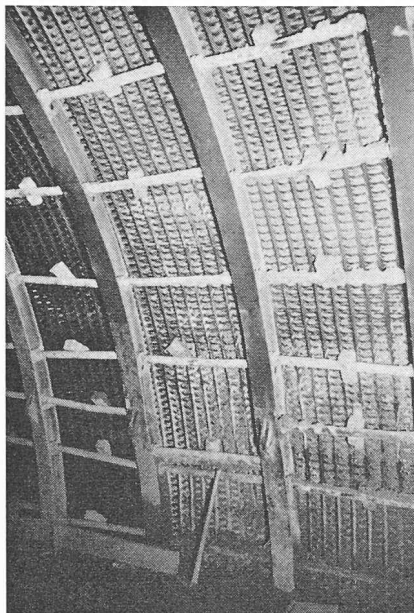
Les cintres de montage servent provisoirement de soutien à la voûte de béton. A droite, partie déjà bétonnée.
